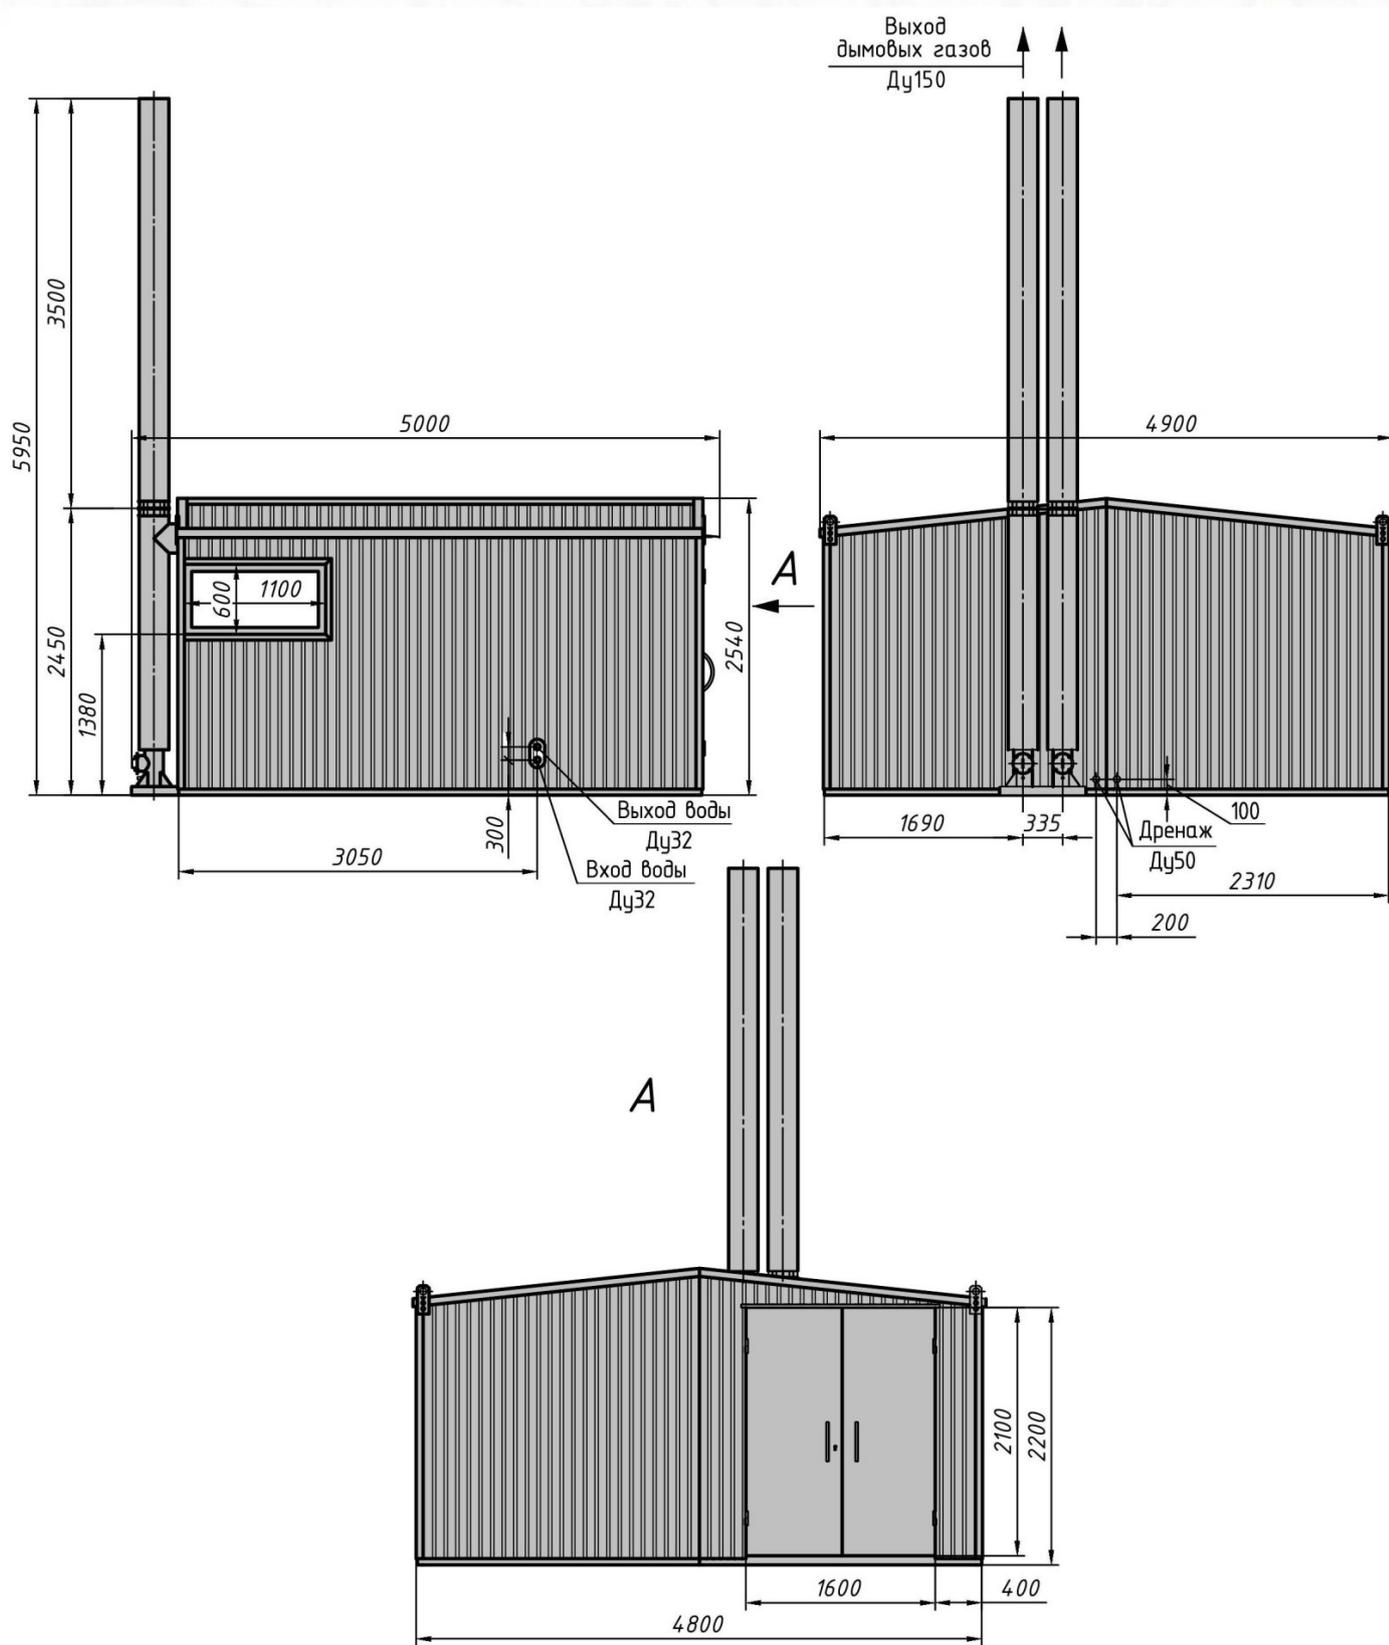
Габаритные и присоединительные размеры БМК(Д)-0,2
